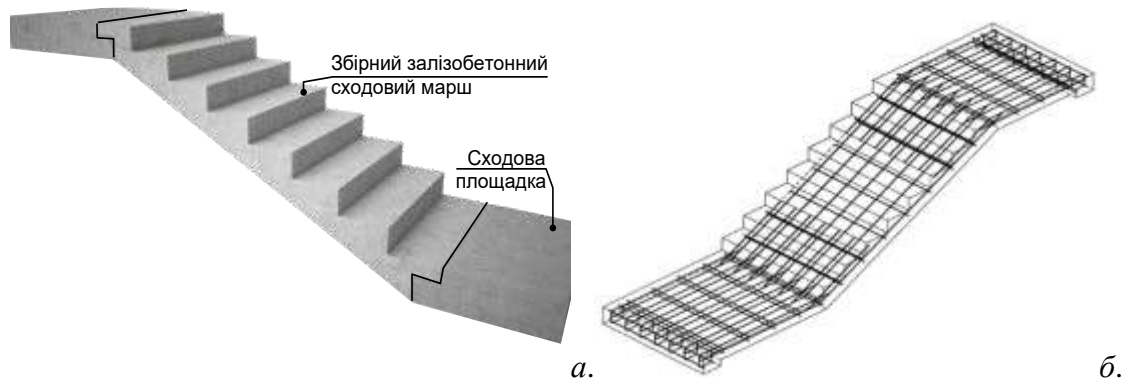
Конструкція збірного залізобетонного сходового маршу (а) та схема його армування (б).
